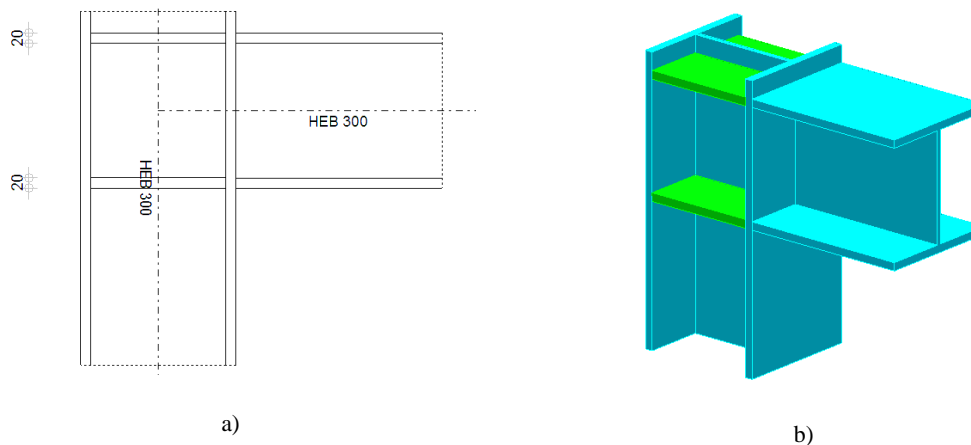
a) Esquema da ligação soldada coluna-viga; b) Esquema 3D da ligação soldada coluna-viga.
